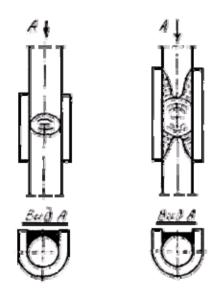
Соединение стыковое на стальной скобе-накладке. Тип 10
